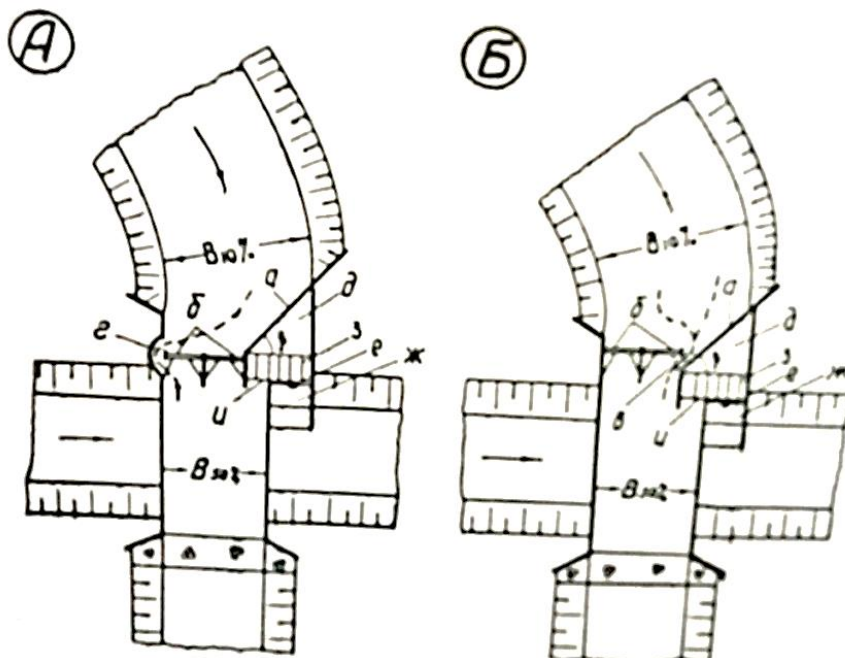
Схемы водопроводяще-водозаборных сооружений с донно-решетчатой галерей: а – струенаправляющая стенка (она же водоприемный водослив); б – подпитывающая камера; в – речные затворы; г, д – промывные отверстия; з – водоприемная галерея, перекрытая грубой решеткой.
